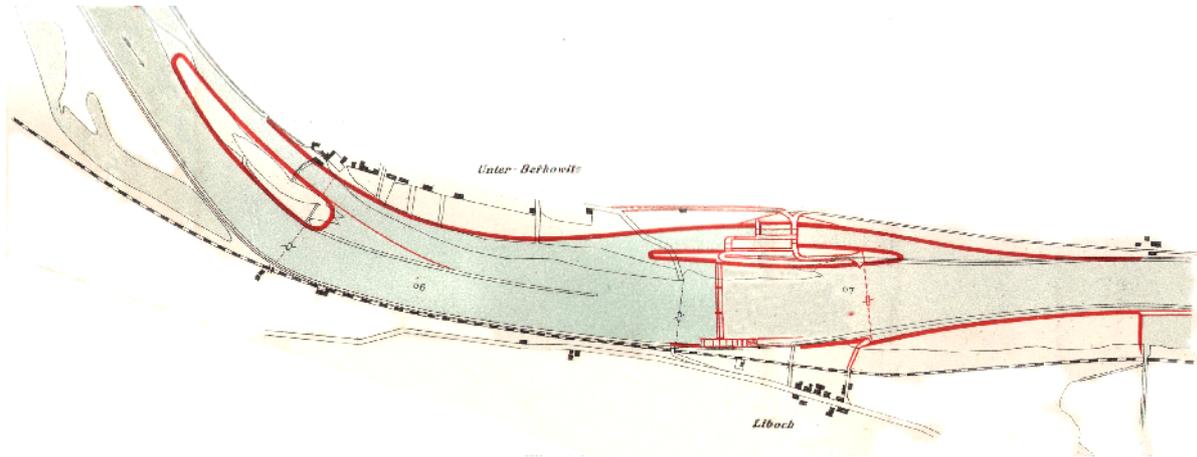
Detailplan der Staustufe VI bei Unter-Beřkovic
